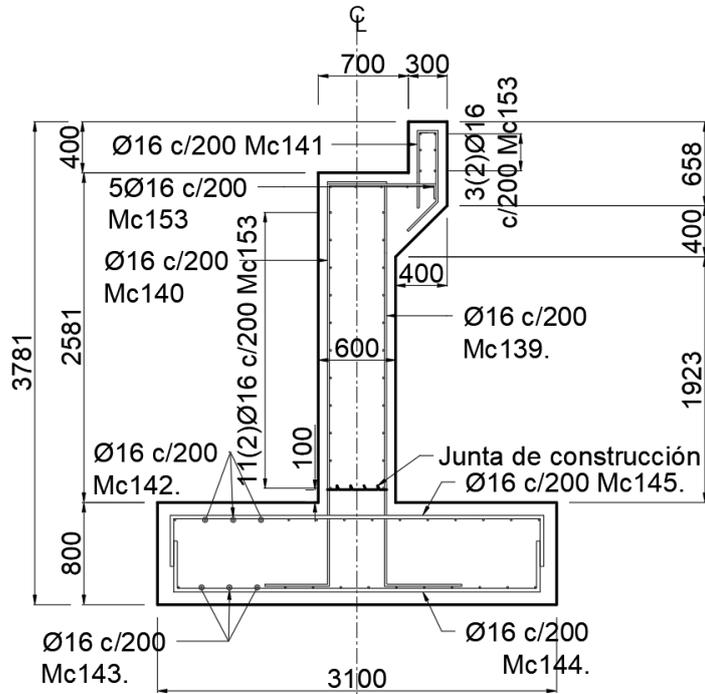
Armado de estribo 2 [Elaboración propia]
